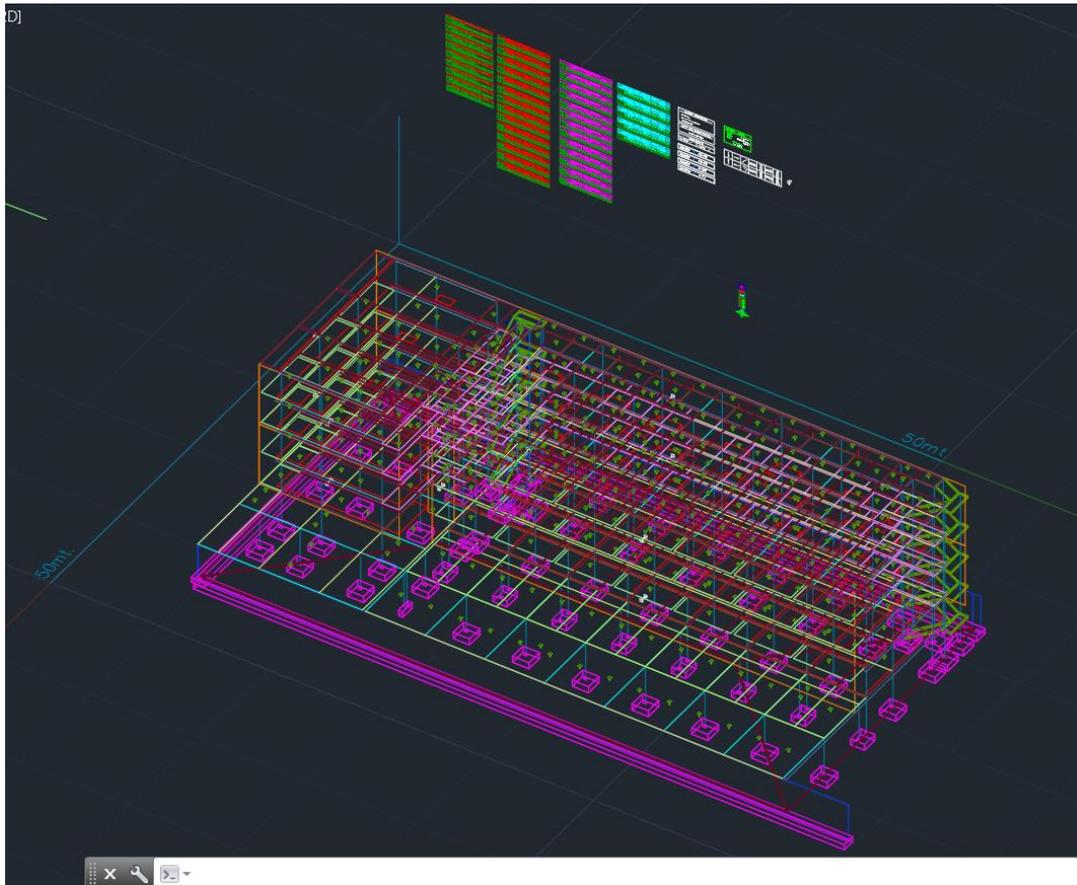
Modelado 2 en AutoCAD con cargas aplicadas
